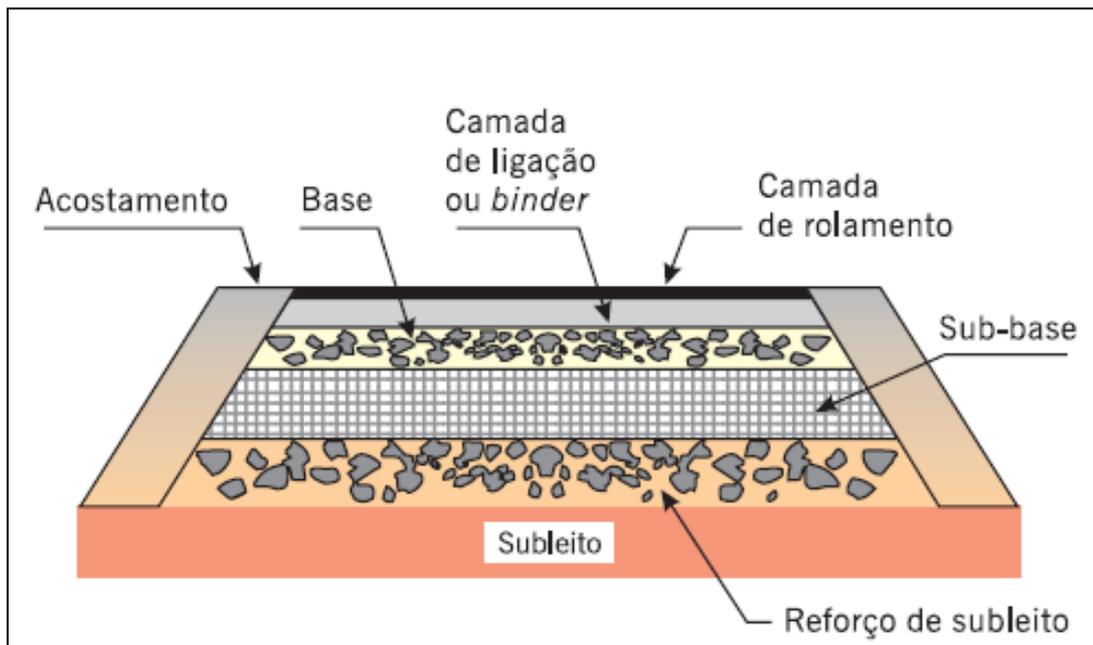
Pavimento asfáltico-corte transversal (BERNUCCI et al., 2006).
